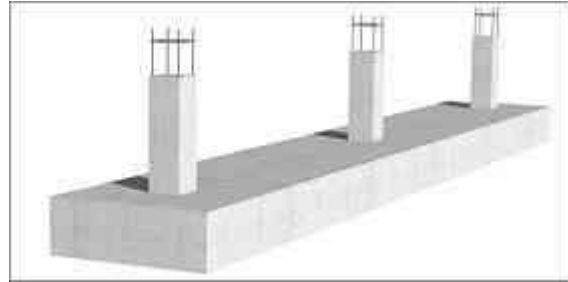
Se muestra una zapata corrida. Fuente : <http://guiasconcreto.mex.tl/imagesnew2/0/0/0/1/1/0/6/4/5/7/zapata-corrida.jpg>
